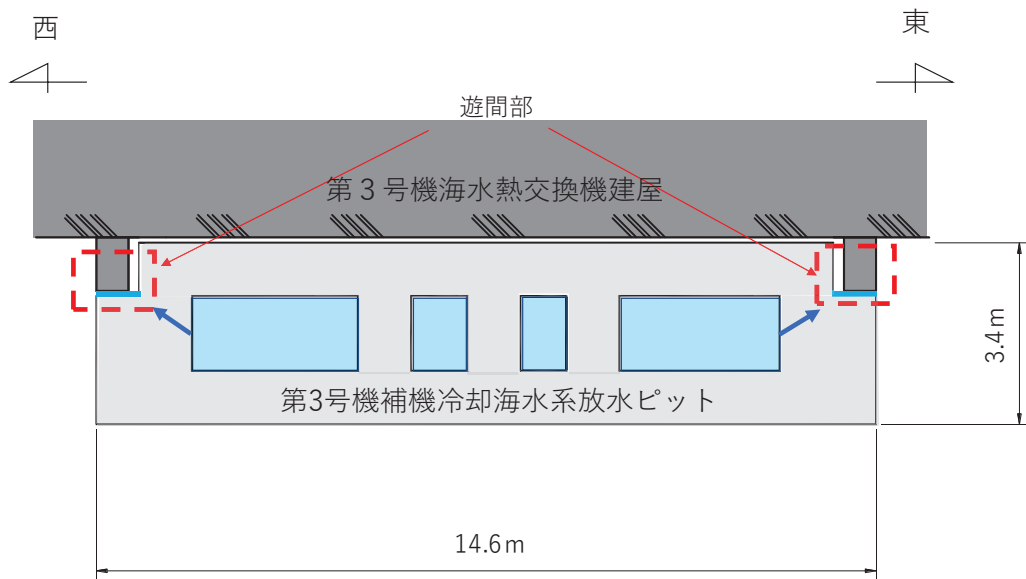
第 3 号機補機冷却海水系放水ピット平面図 (C-C 断面)
